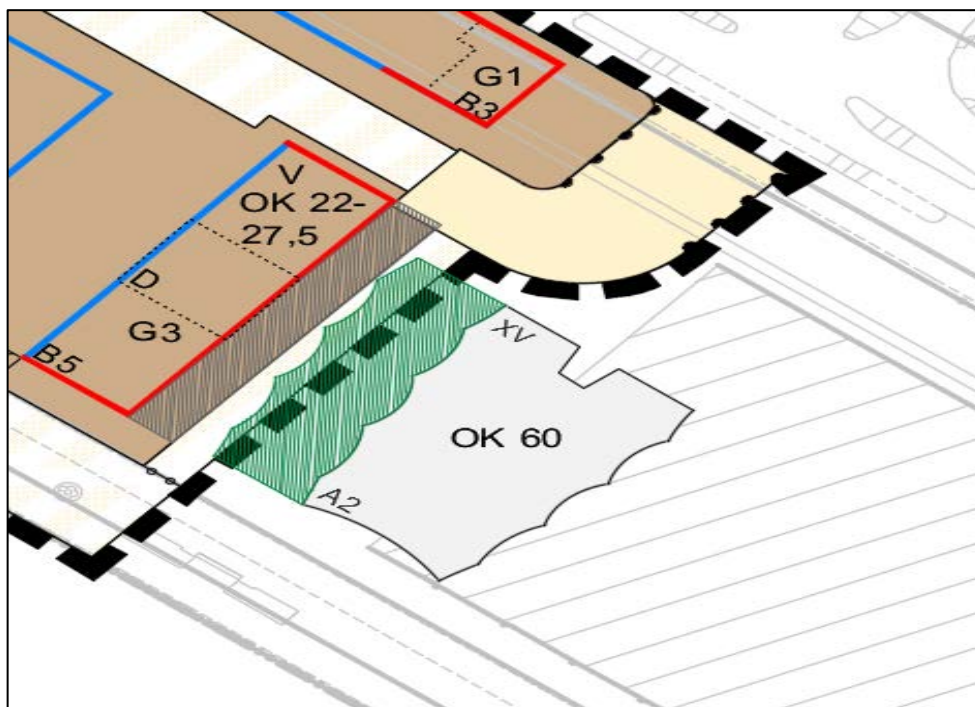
Darstellung der nachbarschützenden Abstandsfläche (0,3 H) für den im Bebauungsplan 2455 B geplanten Hochpunkt (Gebäude A2) unter Berücksichtigung lediglich der Geschosse mit Wohnnutzungen (ab dem vierten Vollgeschoss), und Darstellung der nachbarschützenden Abstandsfläche (0,3 H) für das Baufeld B5
